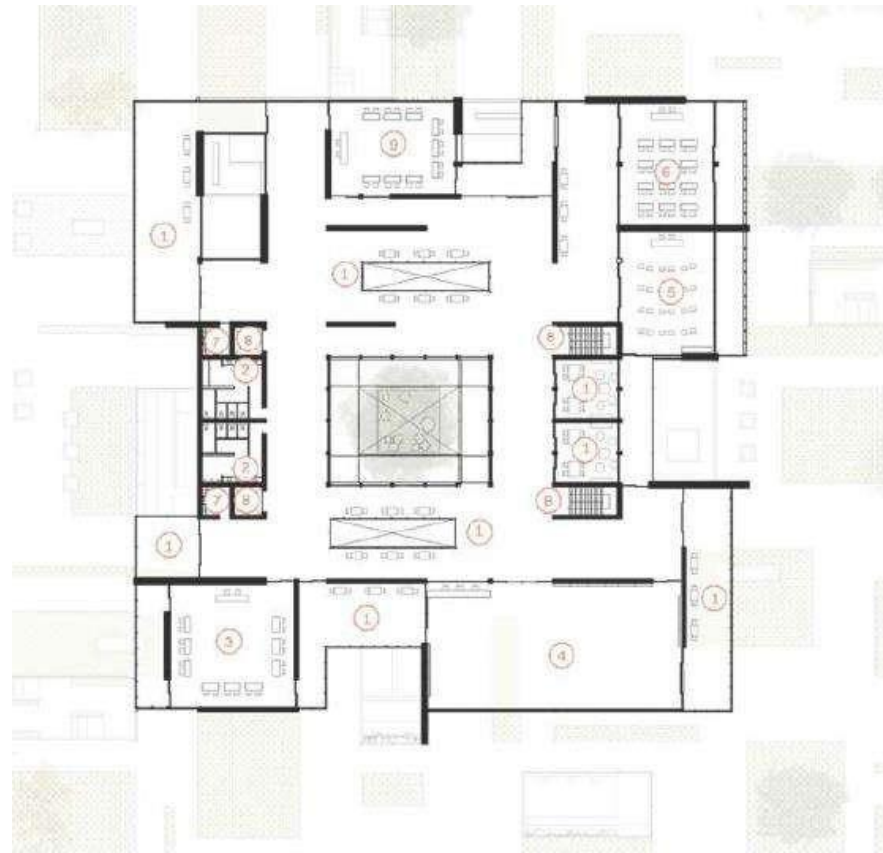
Plantas Arquitectónicas. Elaboración propia.
